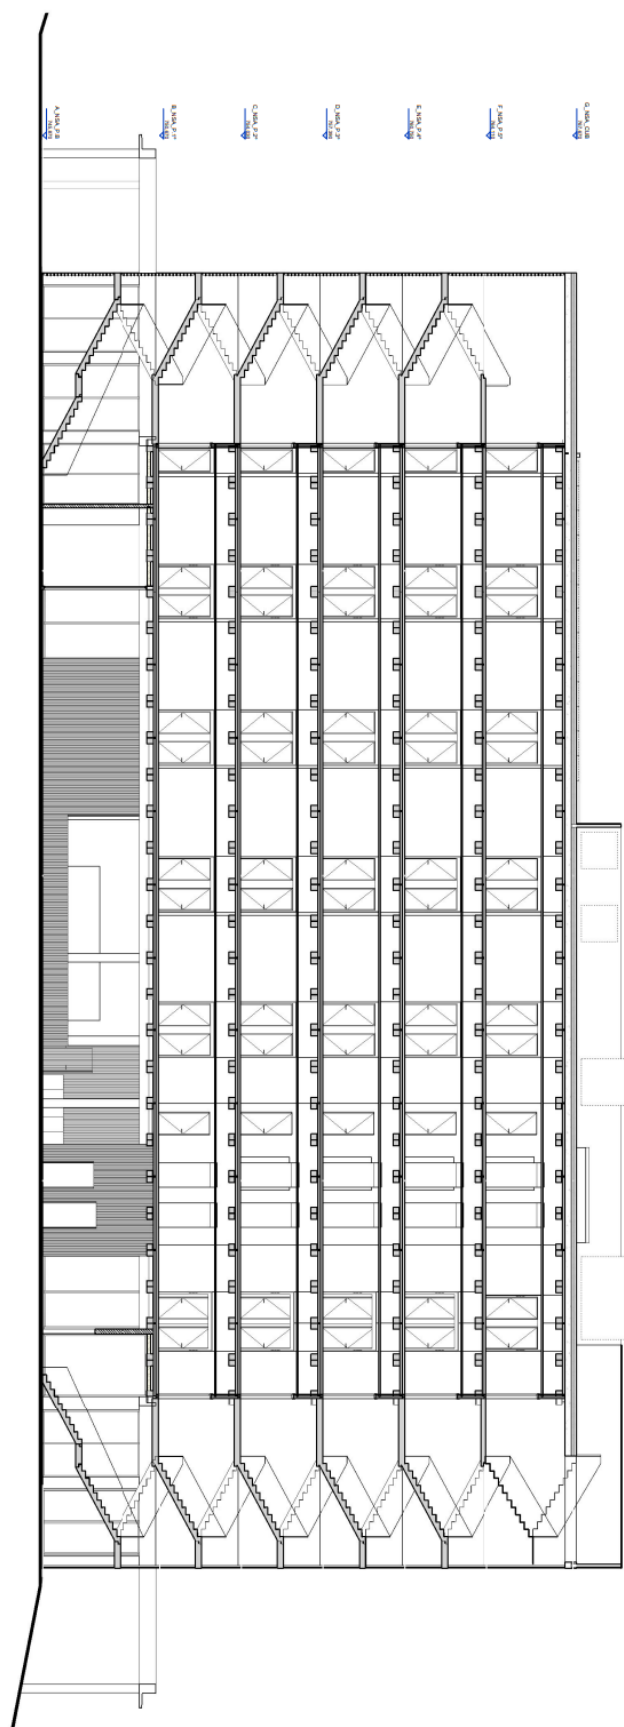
Corte longitudinal - Hotel "Tres Cantos" em Madrid (sem escala)
